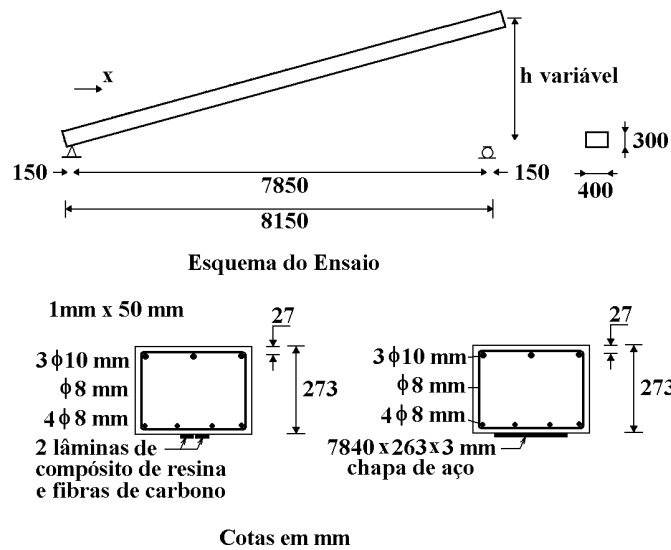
Detalhe das Vigas Ensaaiadas por ERKI e MEIER (1999)
